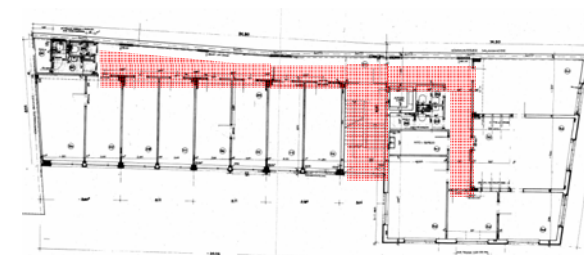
Grundriss Regelgeschoss 3.OG
